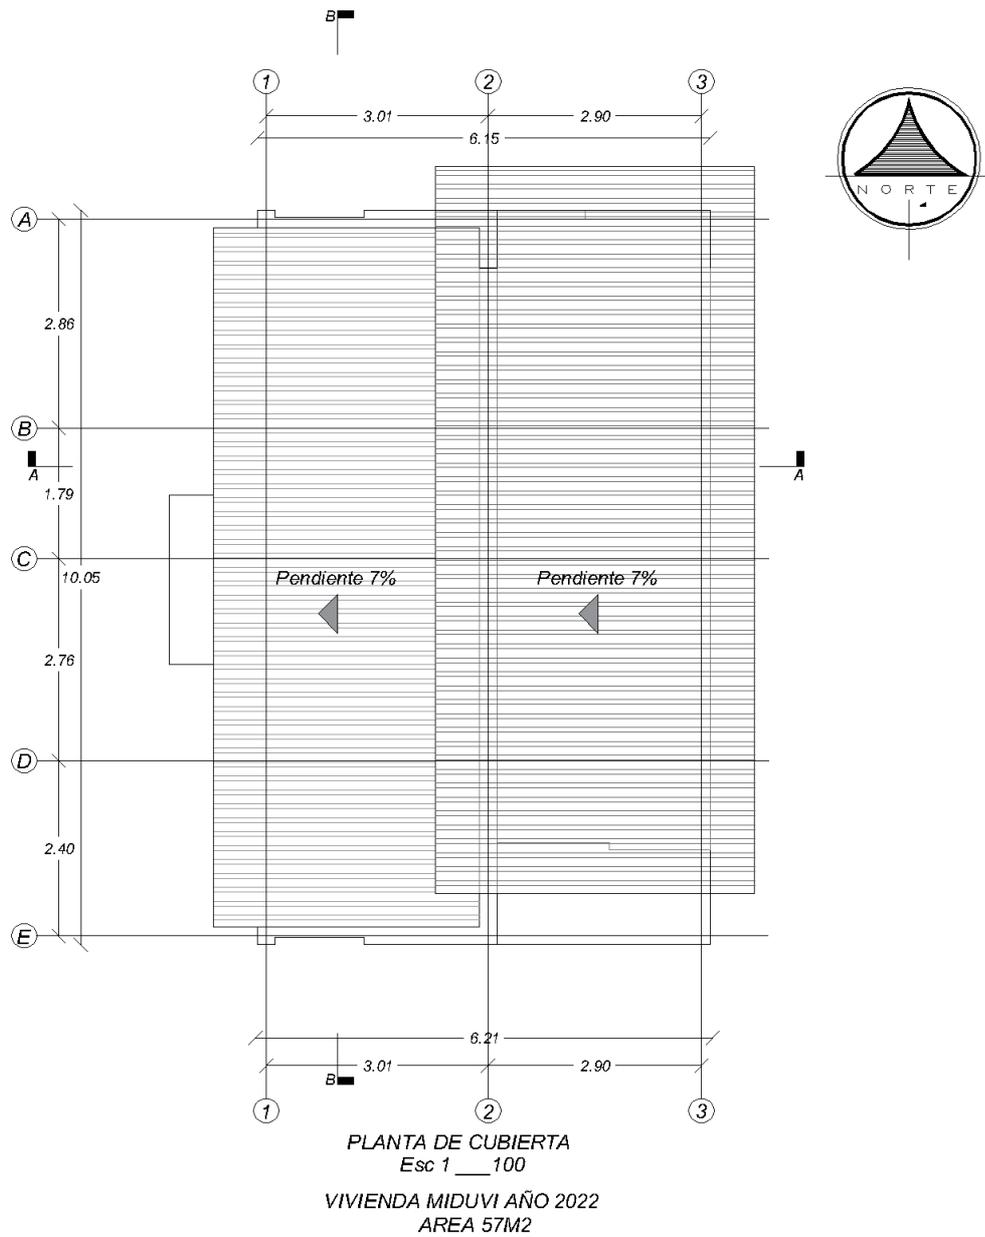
Planta de Cubiertas de Vivienda Social (MIDUVI).
